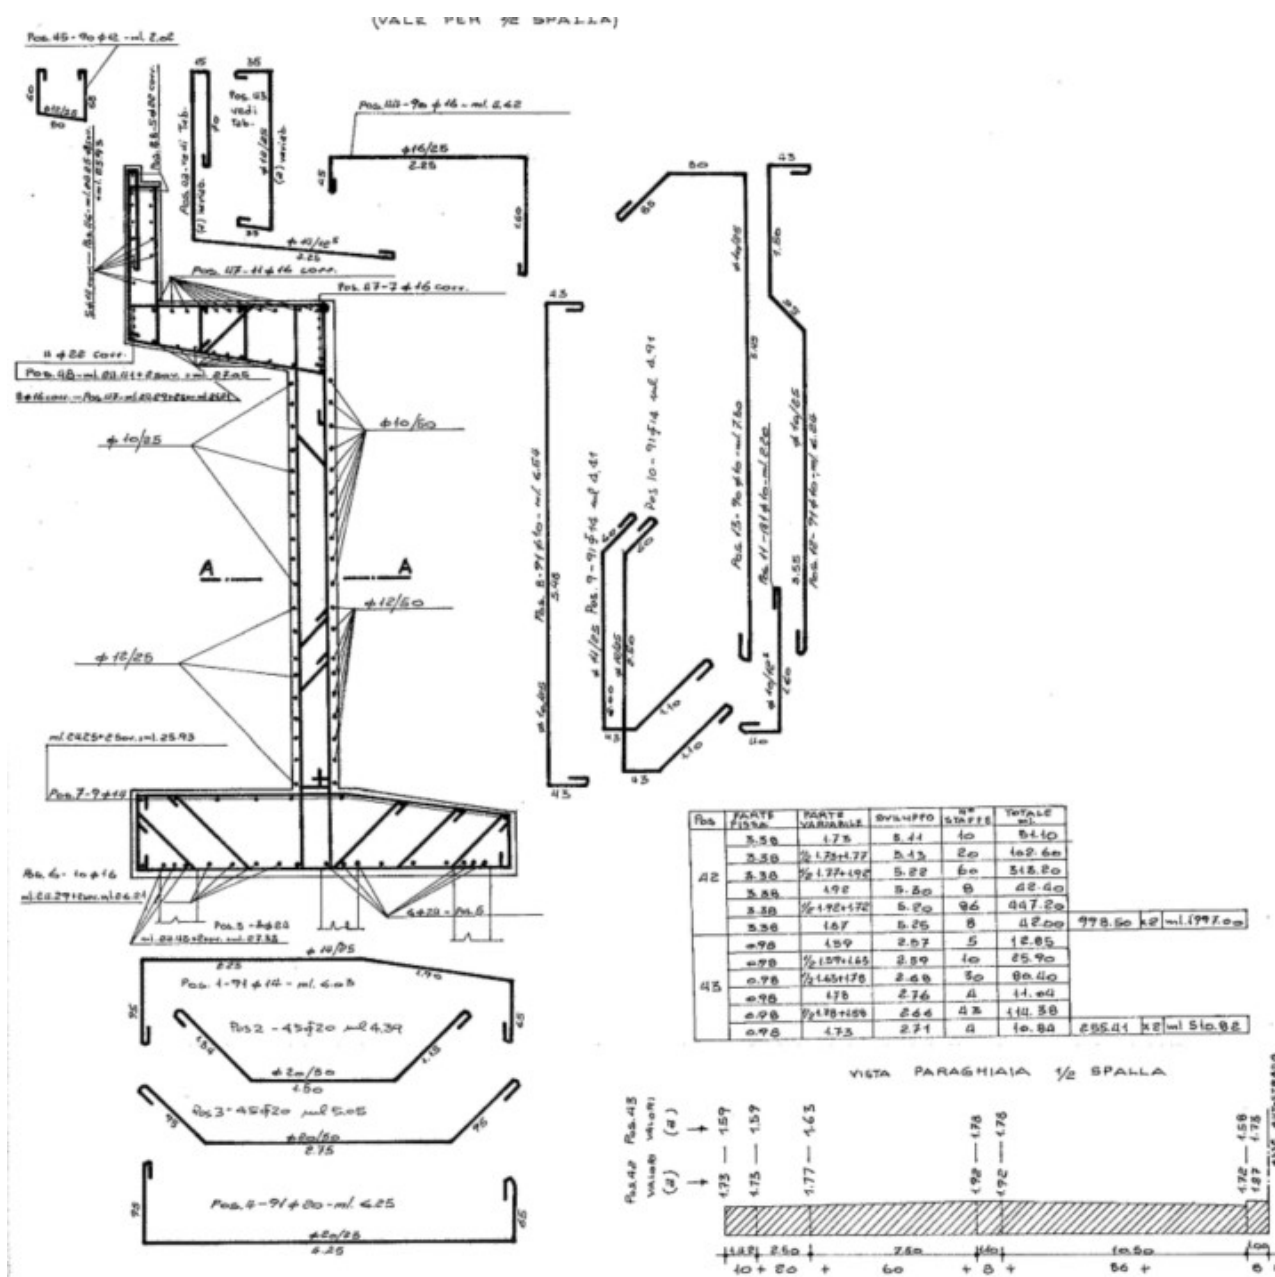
Documento as-built “Sottovia Interconnessione 1 dell’autostrada A14 al km 14+232” – Sezione trasversale con armature spalla.
